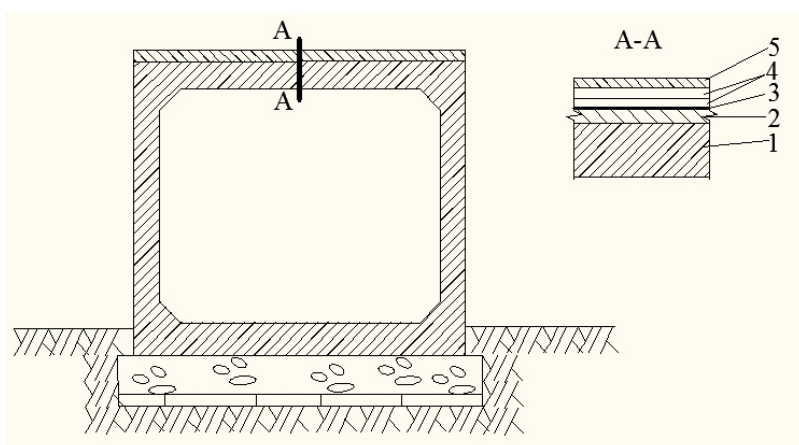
Гидроизоляция типа БМ-3 (обмазочная) для сборных железобетонных прямоугольных водопропускных труб: 1 – звено трубы; 2 – подготовительный слой; 3 – битумная грунтовка; 4 – два слоя битумной мастики толщиной 2,5–3 мм; 5 – защитный слой толщиной 30 мм цементного бетона марки М-150
